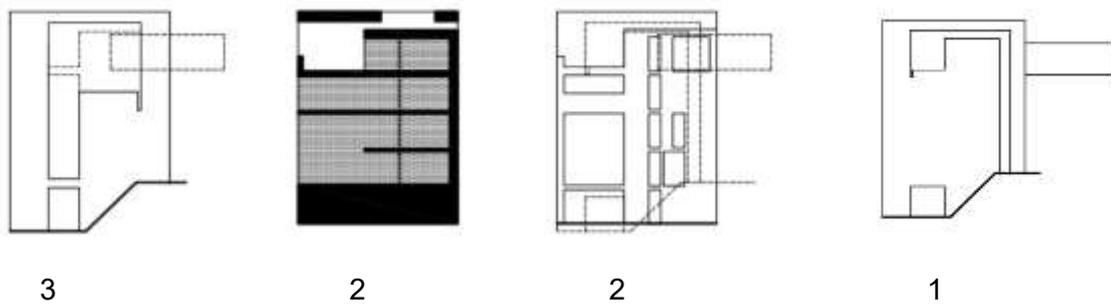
Diagrammes de l'auteur Coupes et élévations est-ouest de la façade nord à l'élévation intérieure de la façade sud
